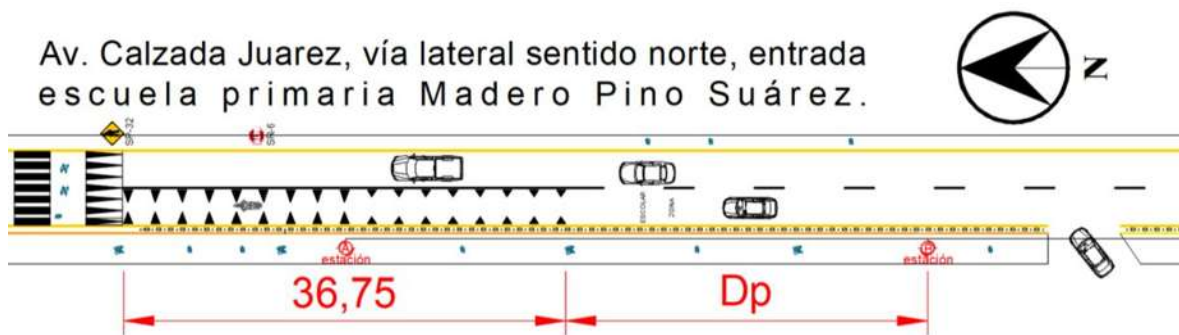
Planta geométrica de la zona escolar 04. Elaboración propia
